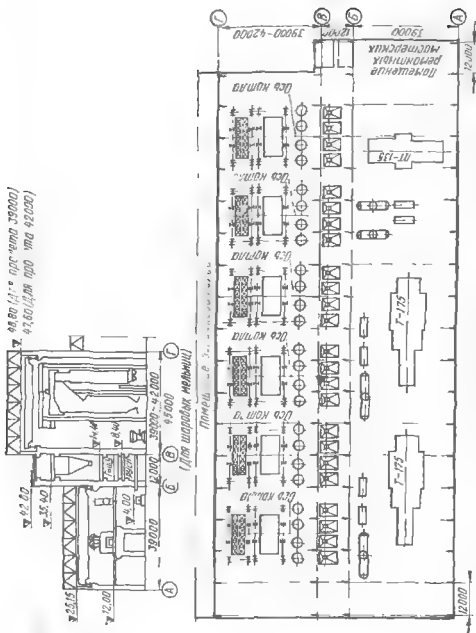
Главные корпус серийной пеллеговой ТЭЦ-ЗИТТ:
